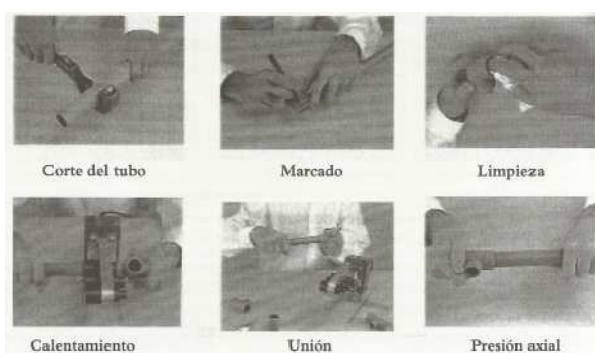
Proceso de soldadura por termofusión en tubería de PP<sup>89</sup>
